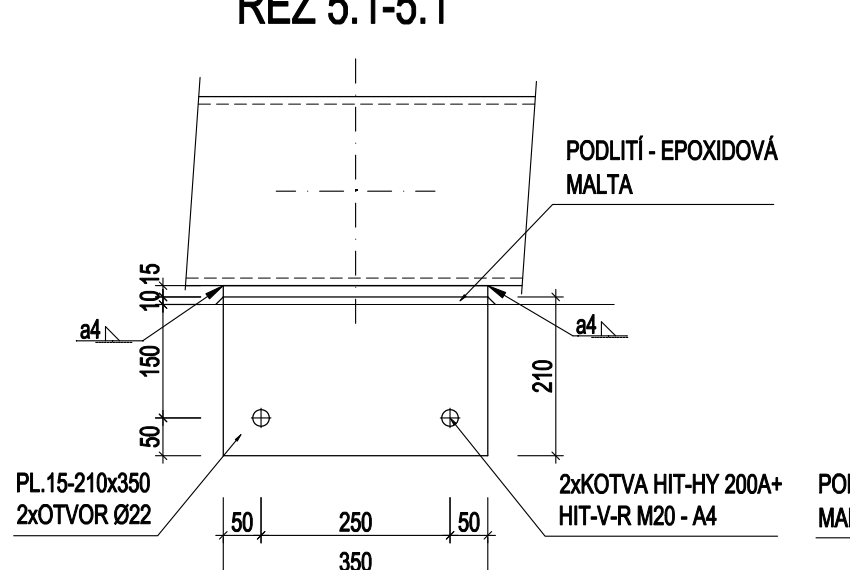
KOTVENÍ PŘÍČLE NA JÁDRO
